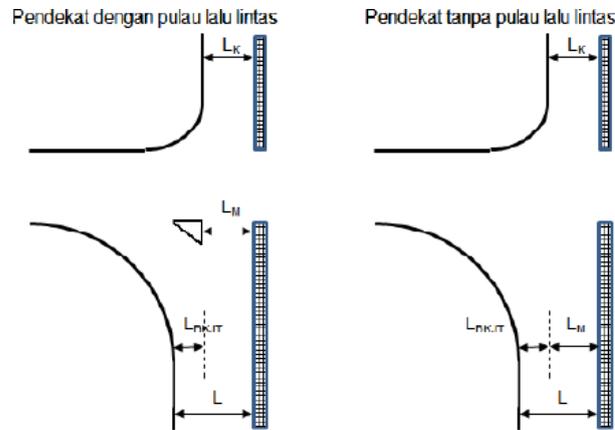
Penentuan Tipe Pendekat (PKJI, 2014).
